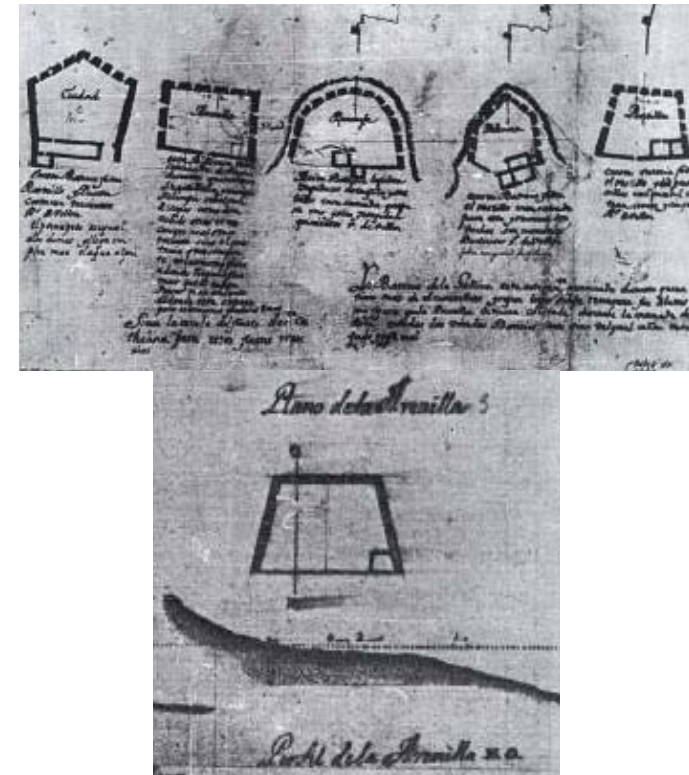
Plano conjunto y planta y sección del Fuerte del siglo XVIII.
